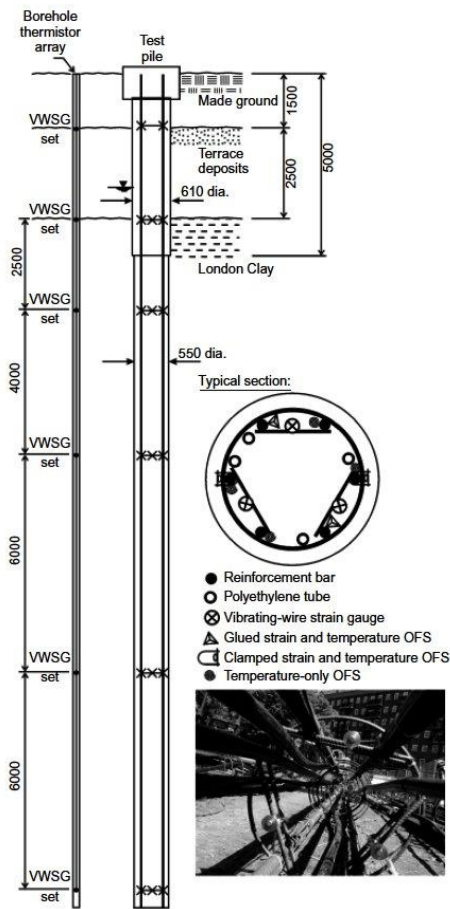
Instrumentación instalada en el pilote (Bourne-Webb et al., 2009).
